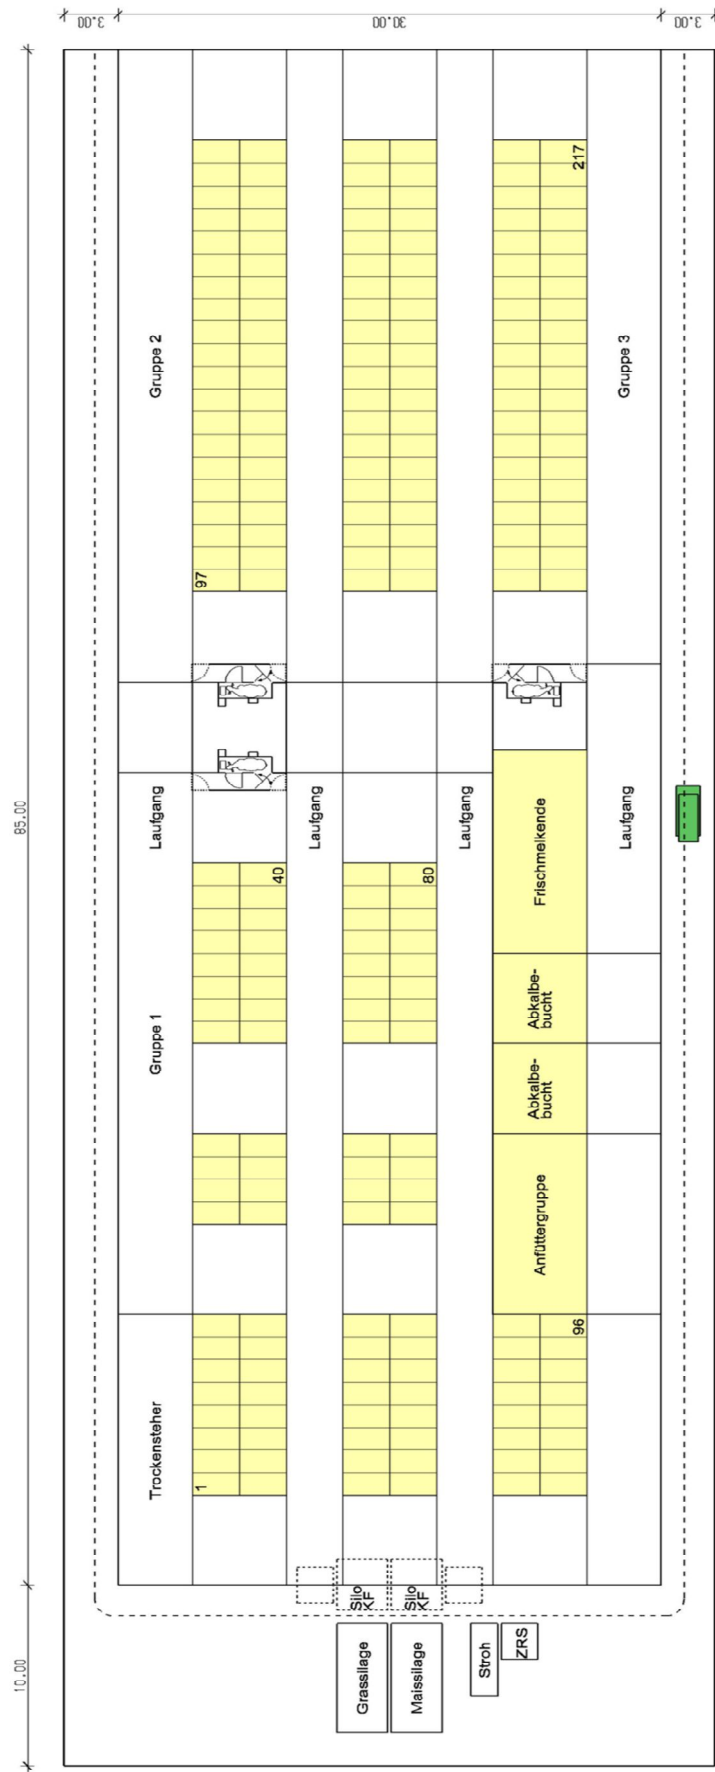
Stallgrundriss Betrieb 6 (KF: Kraftfutter, ZRS: Zuckerrübenasschnitzel, siliert)
